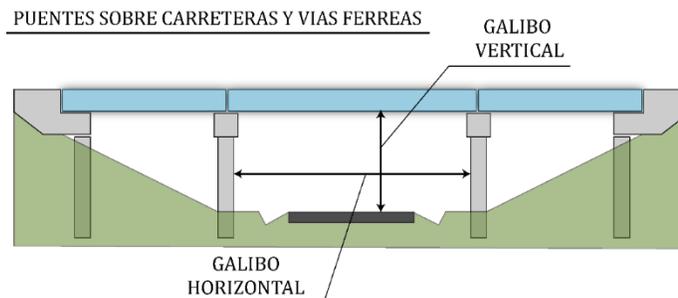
Gálibo horizontal y vertical bajo el puente.
